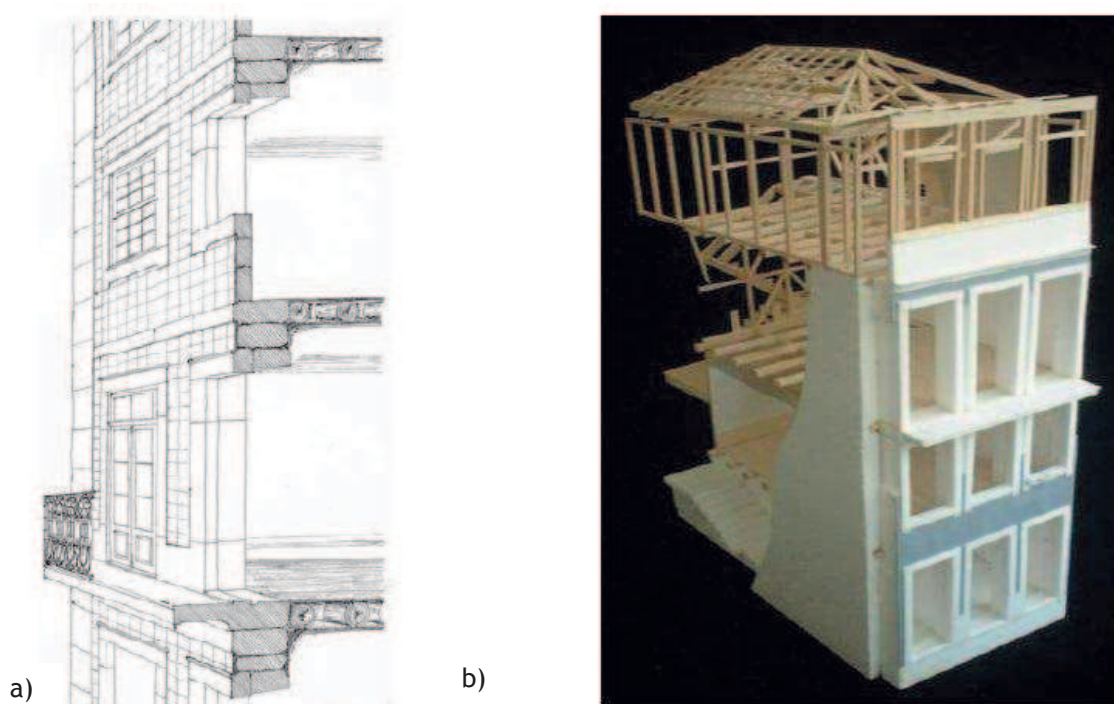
a) Fachada em pedra; b) Aplicação de paredes em madeira [Teixeira 2004].
